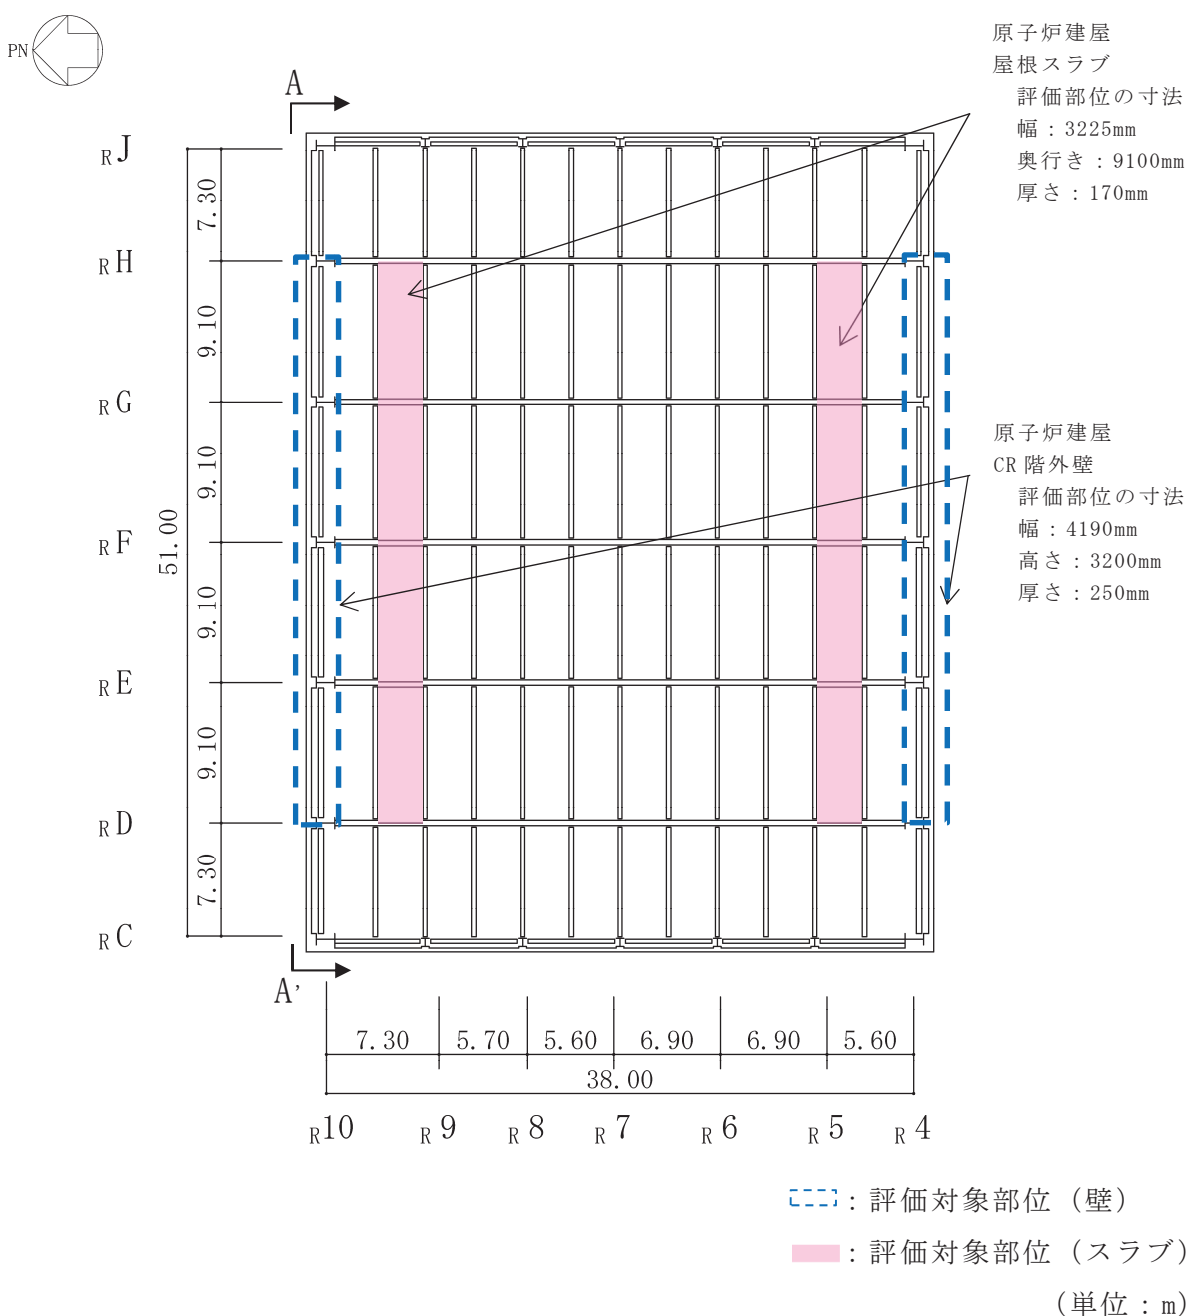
原子炉建屋の概略平面図 (O.P. 50.50m)
